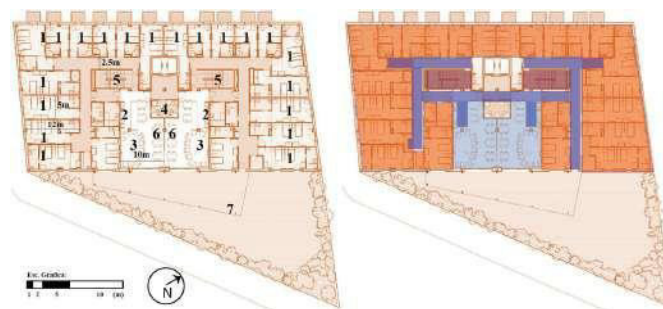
Planta alta. Fuente: Elaboración propia
